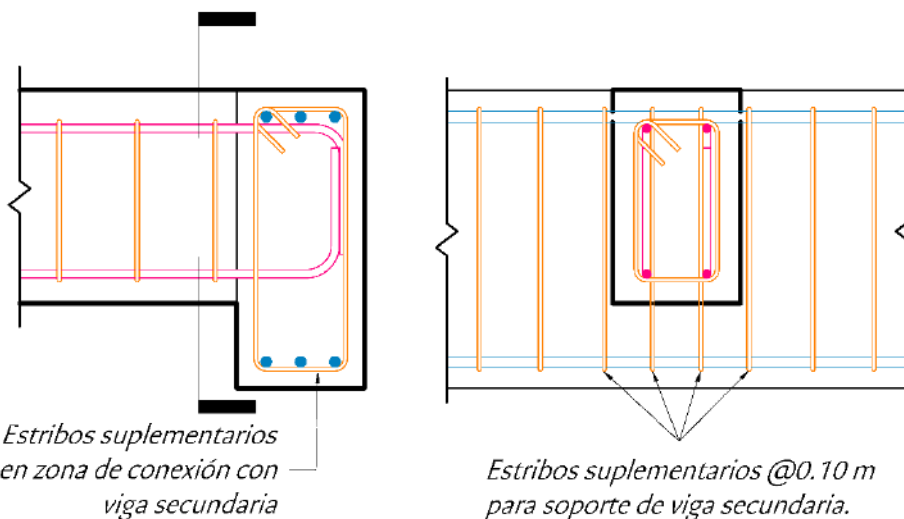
Refuerzo de suspensión. Referencia: 5.9.16.7.1.5.
